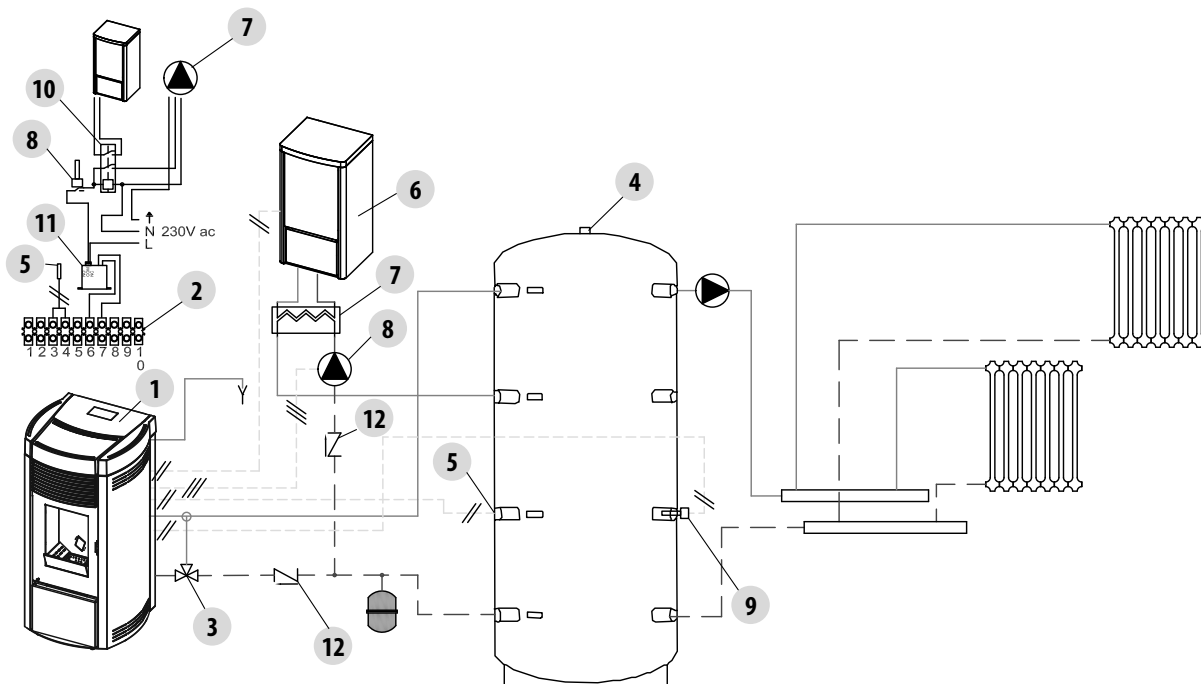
Instalacja z: piecem na pellet, pufferem i kotłem pomocniczym (ściennym)
